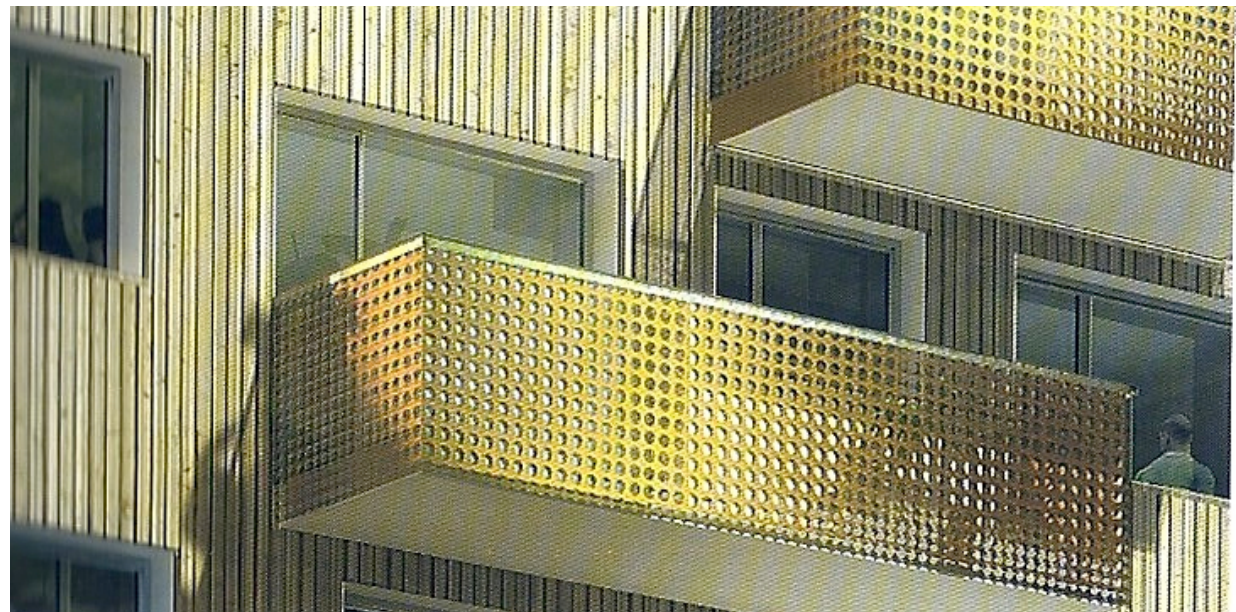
Imagen Detalle constructivo de las Viviendas Sociales Haussman
